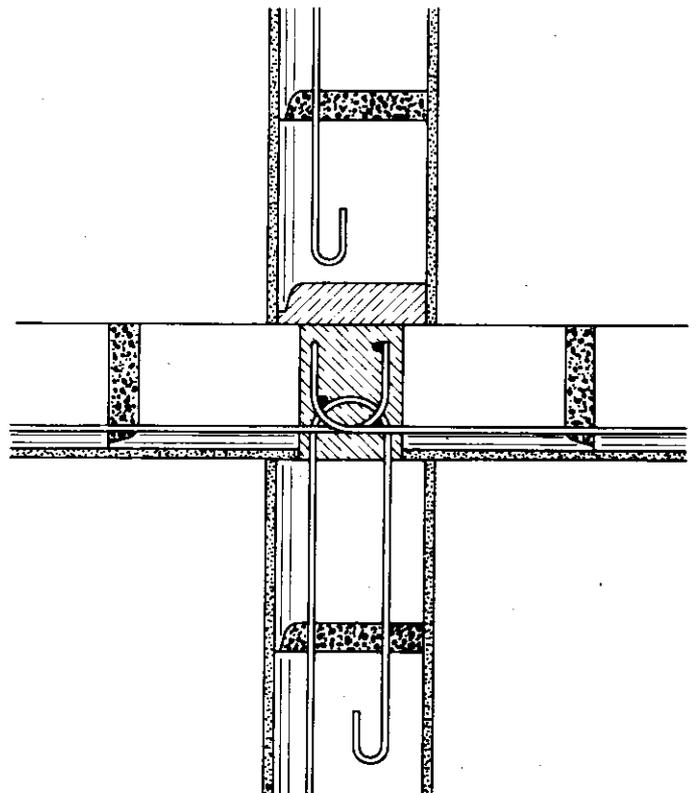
Bewehrte waagerechte Stöße zweier Innenwandtafeln und zweier Deckenplatten einschließlich Ringbalken
